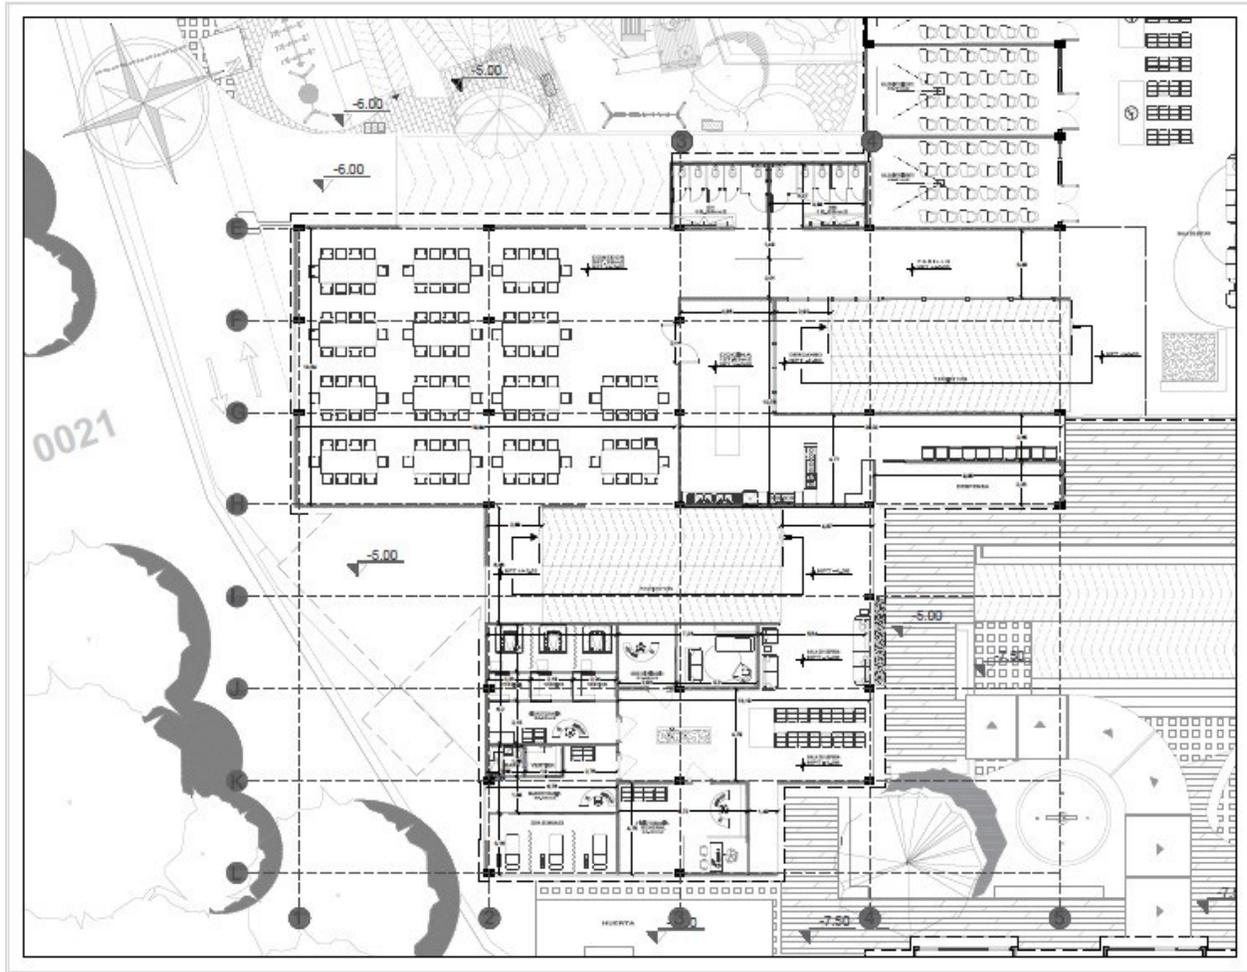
Planta 0 Edificación 2 (Rubiano, 2020)
